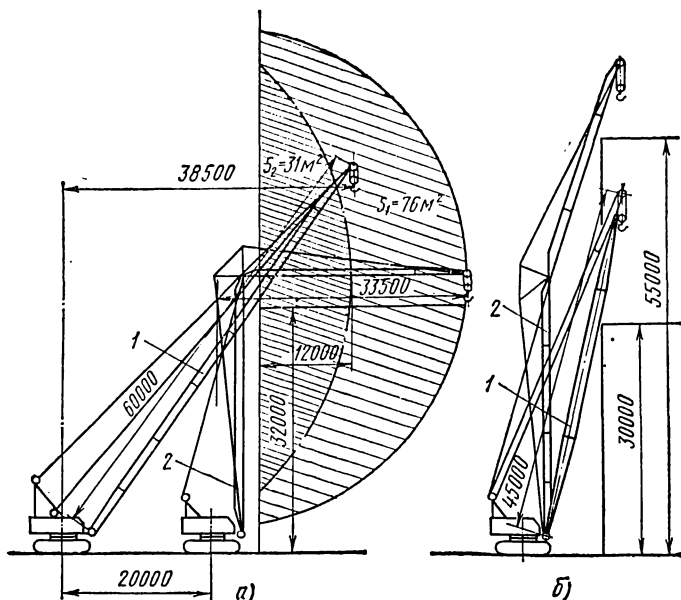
Схема обслуживания зданий кранами с различным стреловым оборудованием:
